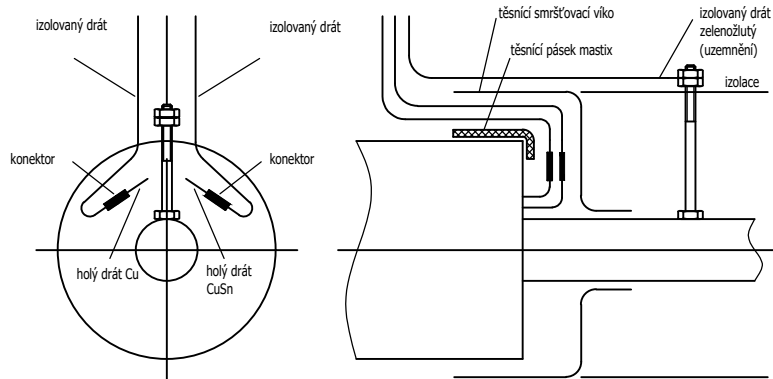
DETAIL VYVEDENÍ DRÁTŮ ALARM-SYSTÉMU
